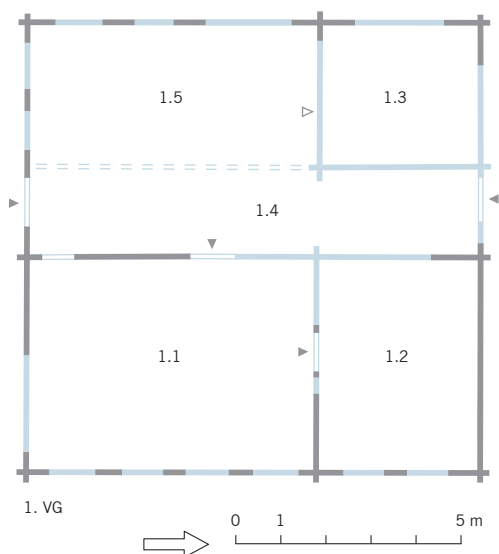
Haus Chammersbüel in Unterägeri, Grundriss des ersten Vollgeschosses.
